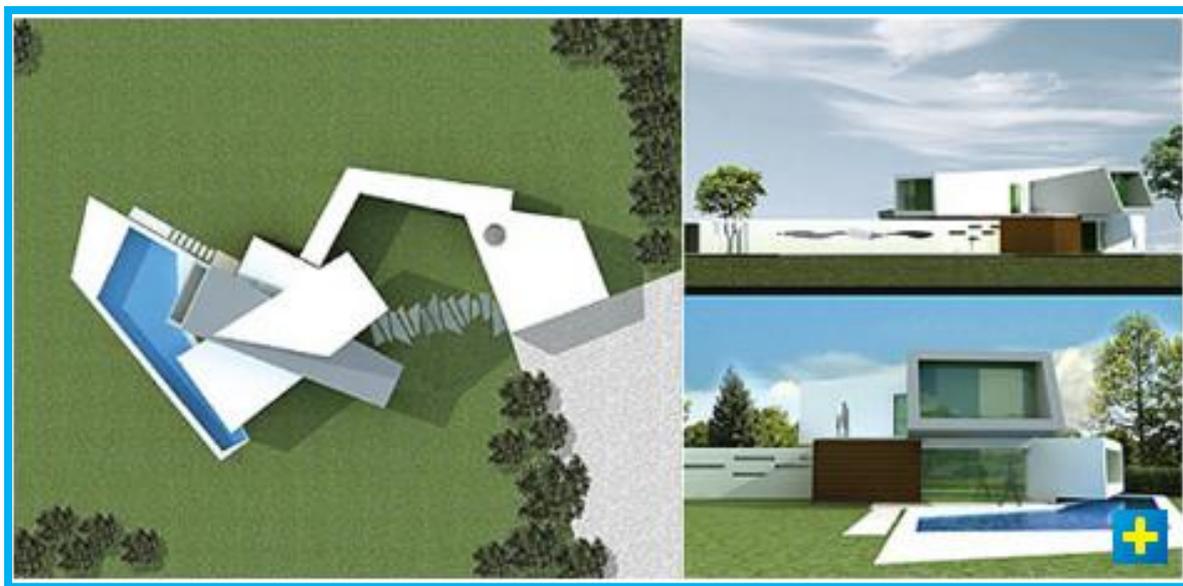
Modelo análogo, Planta arquitectónica y elevaciones.
